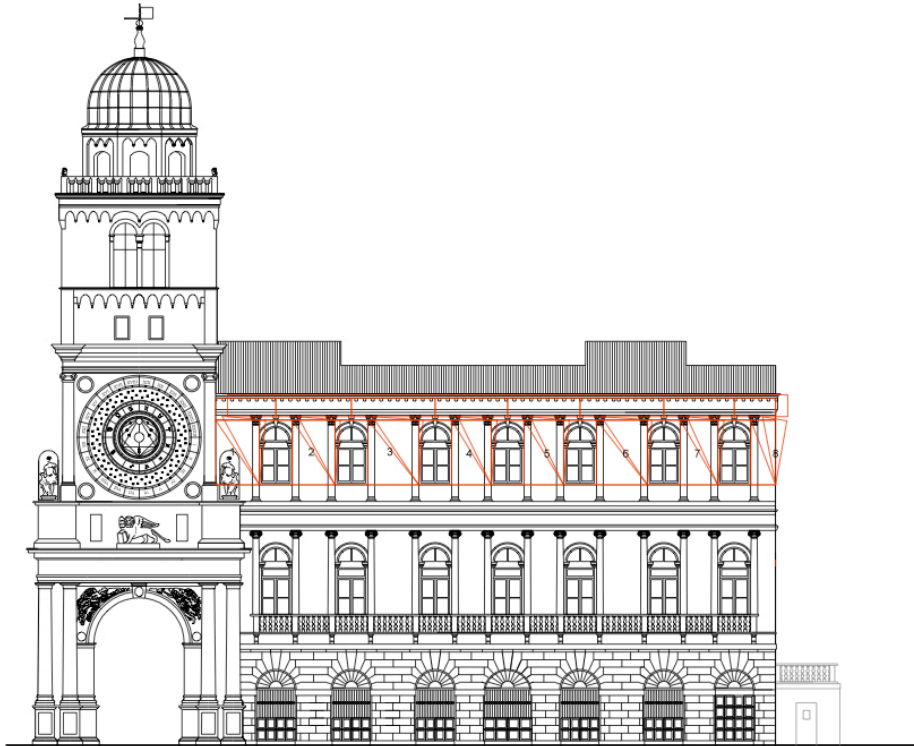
Schematizzazione del ribaltamento nel piano dei maschi murari _ prospetto est
